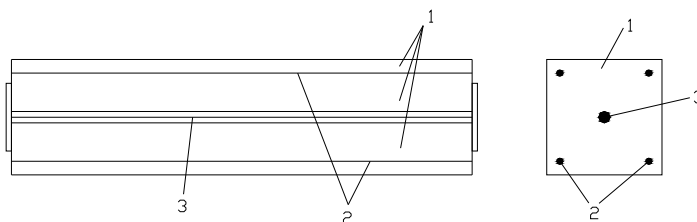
Схема армирования элемента: 1 — нелинейный разномодульный материал (бетон); 2 — ненапрягаемая арматура; 3 — предварительно напряженная арматура (затяжка)
